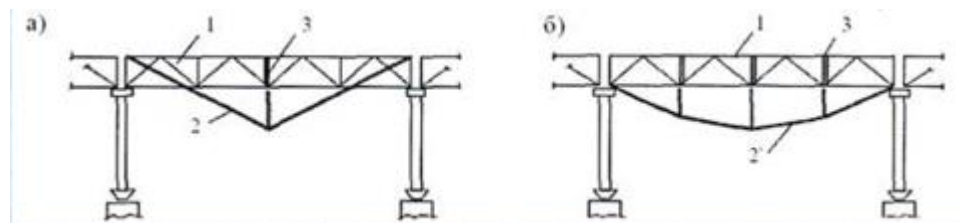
Усиление стропильных ферм путем установки шпренгельных систем, а) – крепление шпренгеля в верхних узлах фермы;
